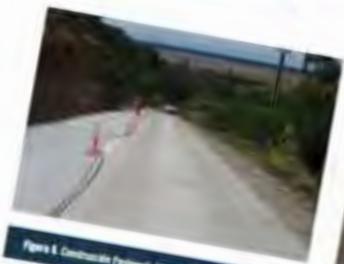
Construcción Pavimento Ultralevigado de Herring con Fibra de Vidrio P-100 Zona de Llanos Panguipón
